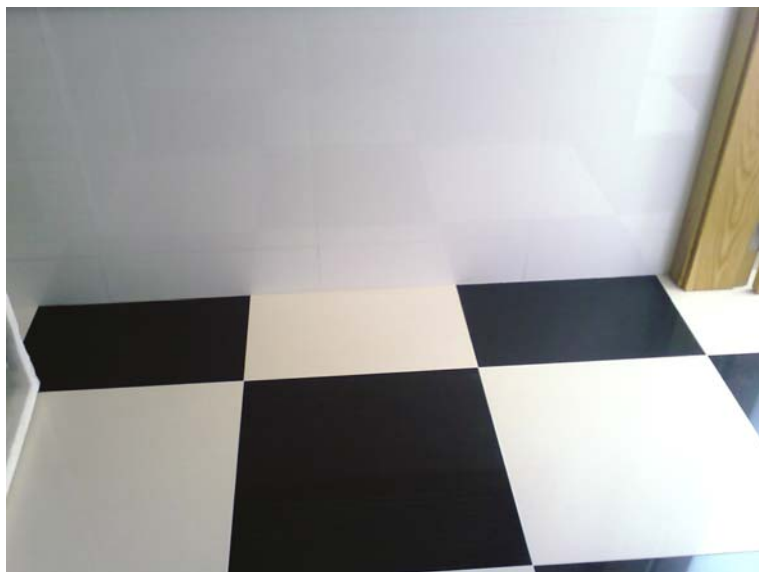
Pormenor da ligação entre o pavimento e a parede da cozinha onde é visível a existência de ligações rígidas através do cimento cola de assentamento do revestimento de piso e da parede.
